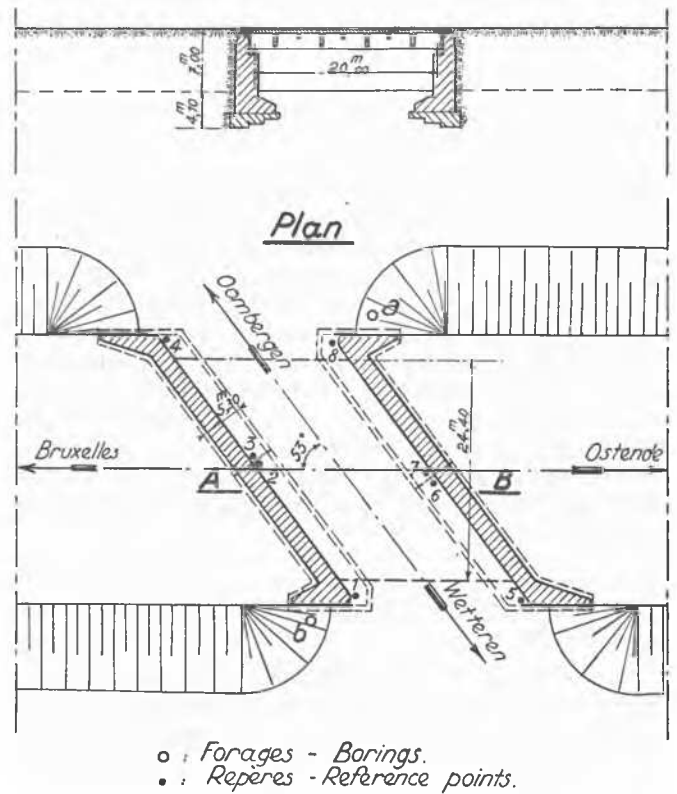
Pont No 24 à Westrem: vue en plan et coupe Bridge No. 24 at Westrem: Plan and Section
